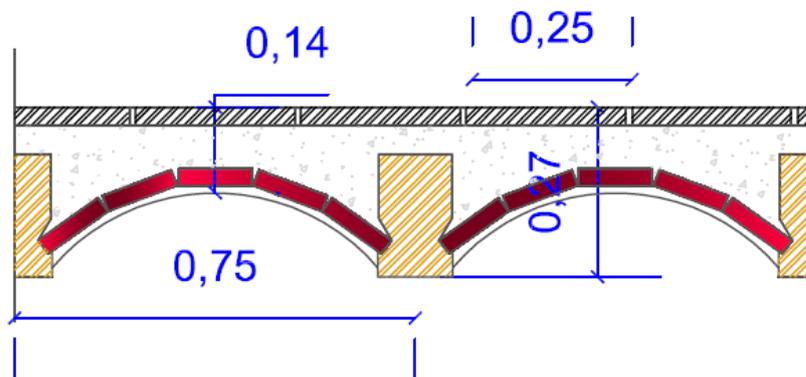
Sección transversal de forjado de forjado. Fuente propia.
